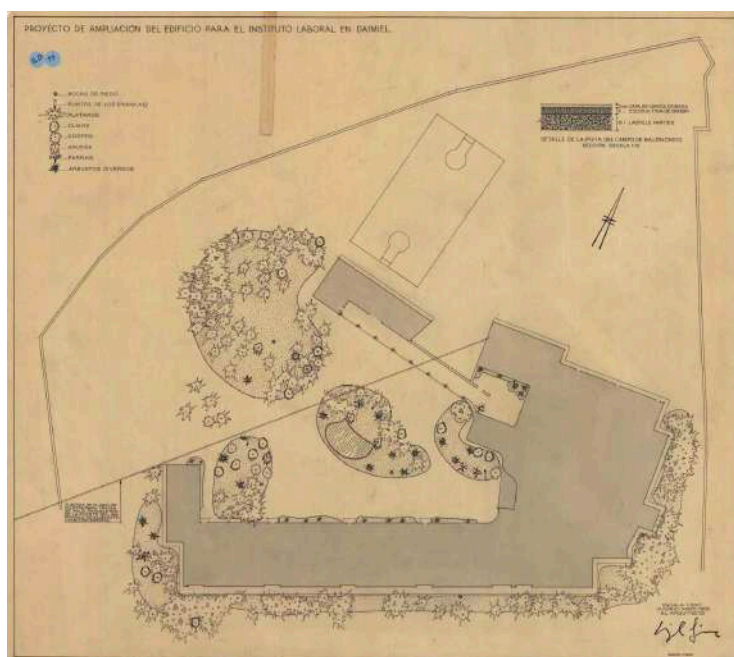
Plano de Jardinería (1953). Archivo Fundación Miguel Fisac
